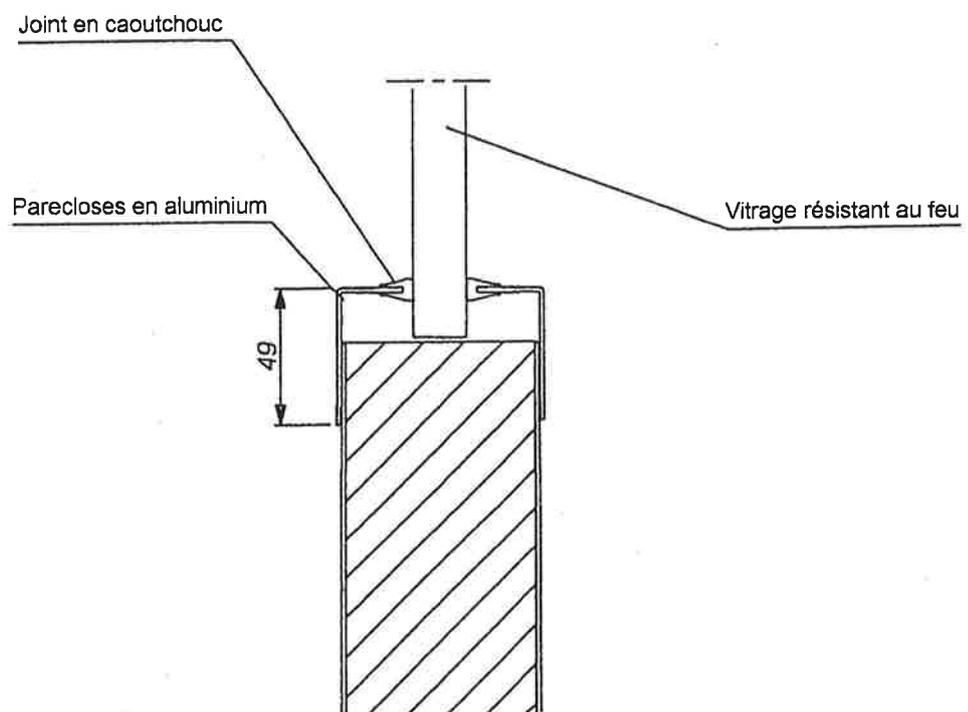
bis : Coupe du vantail à l'endroit des parecloses
